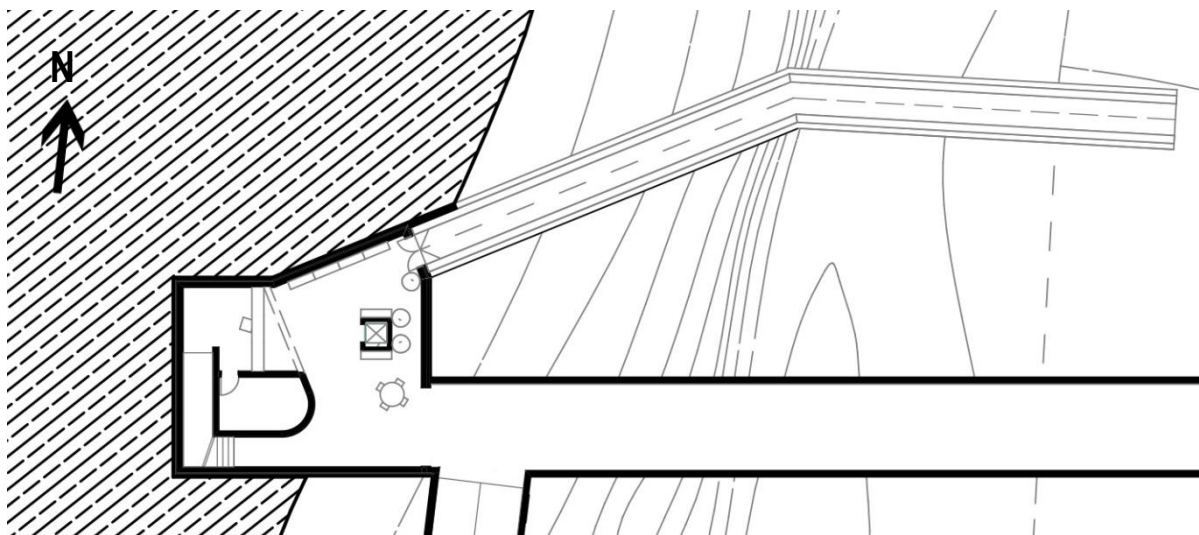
Planta do primeiro nível da Torre, proposta de intervenção, Imagem do autor.
